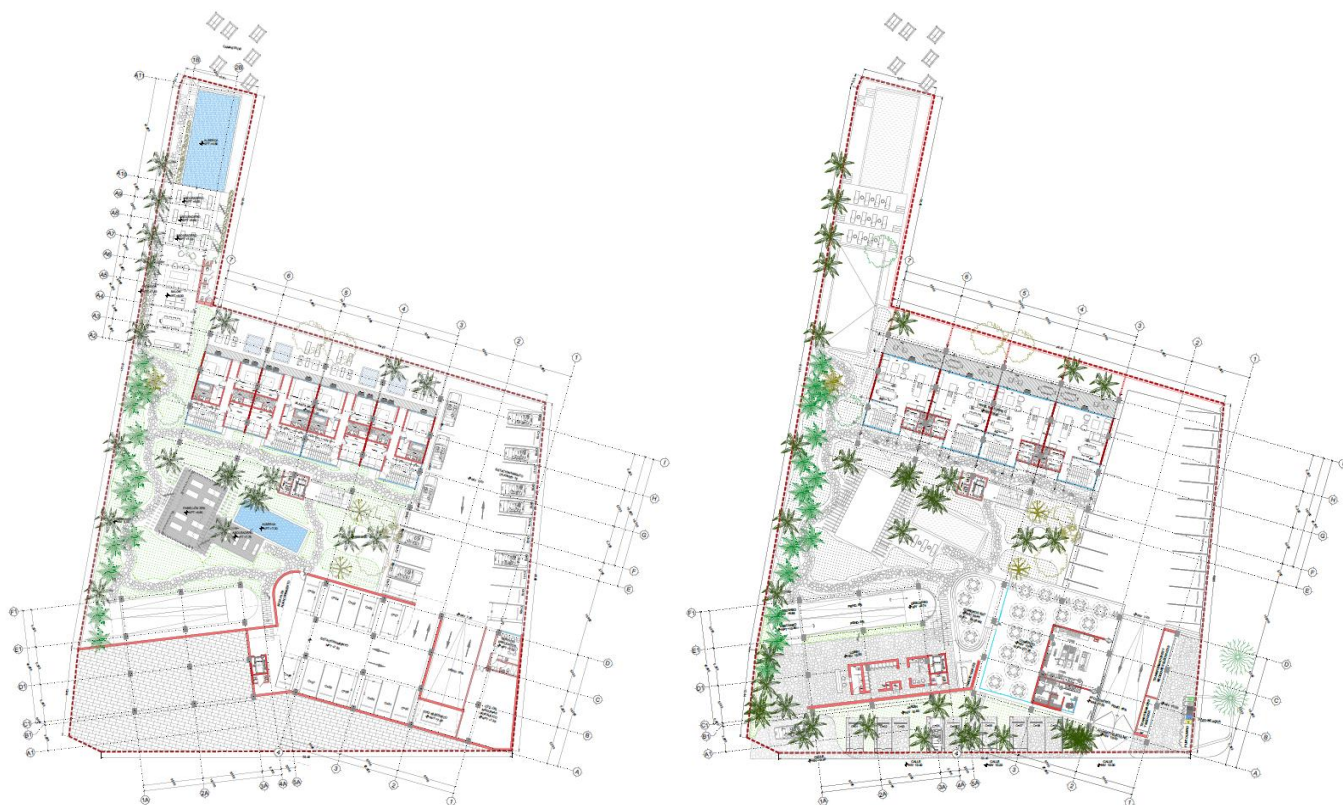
Planta baja de conjunto (izquierda) y Planta Nivel 2 de la Torre C y Nivel 1 de la Torre A y Torre B (derecha)
